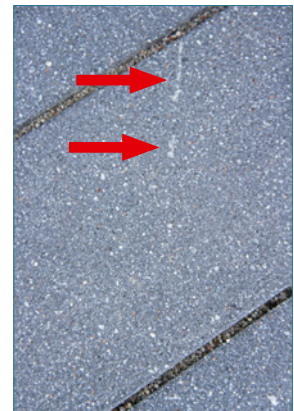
Bild 61: Pflasterdecke mit einzelnen verkratzten Betonplatten
